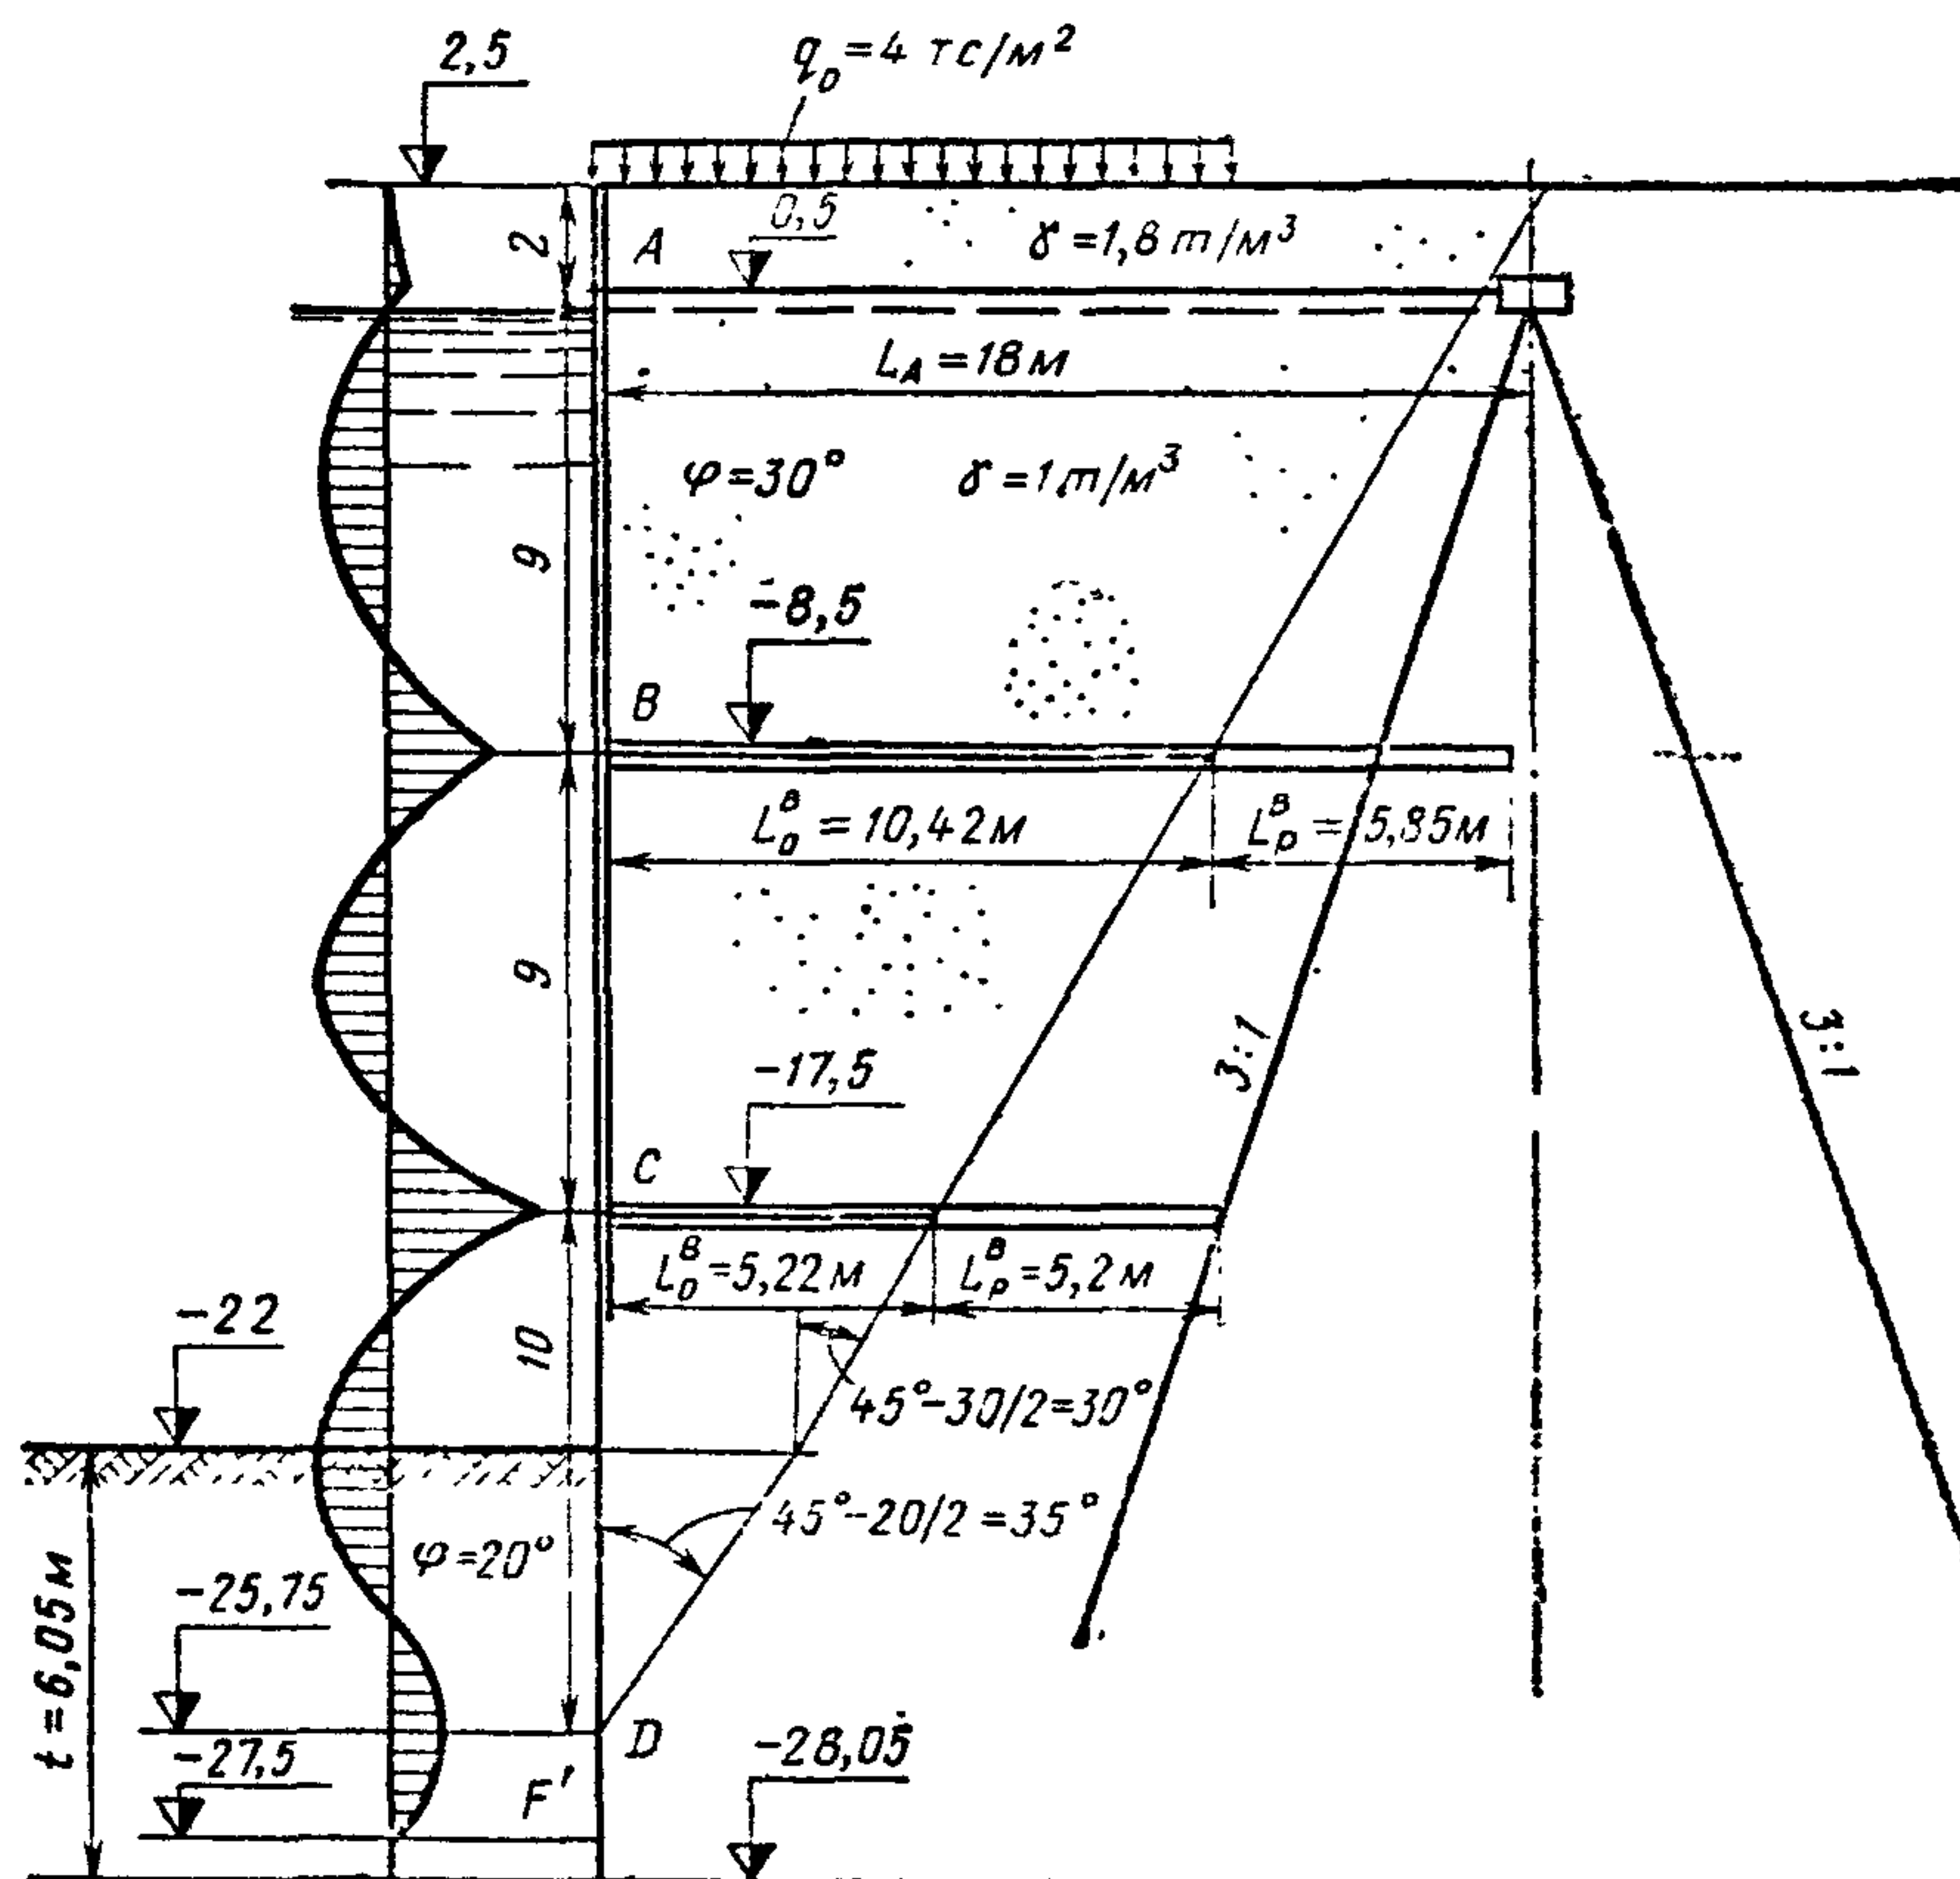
Определение длины анкеров при расчете шпунтовой стенки с анкерровкой на трех уровнях
